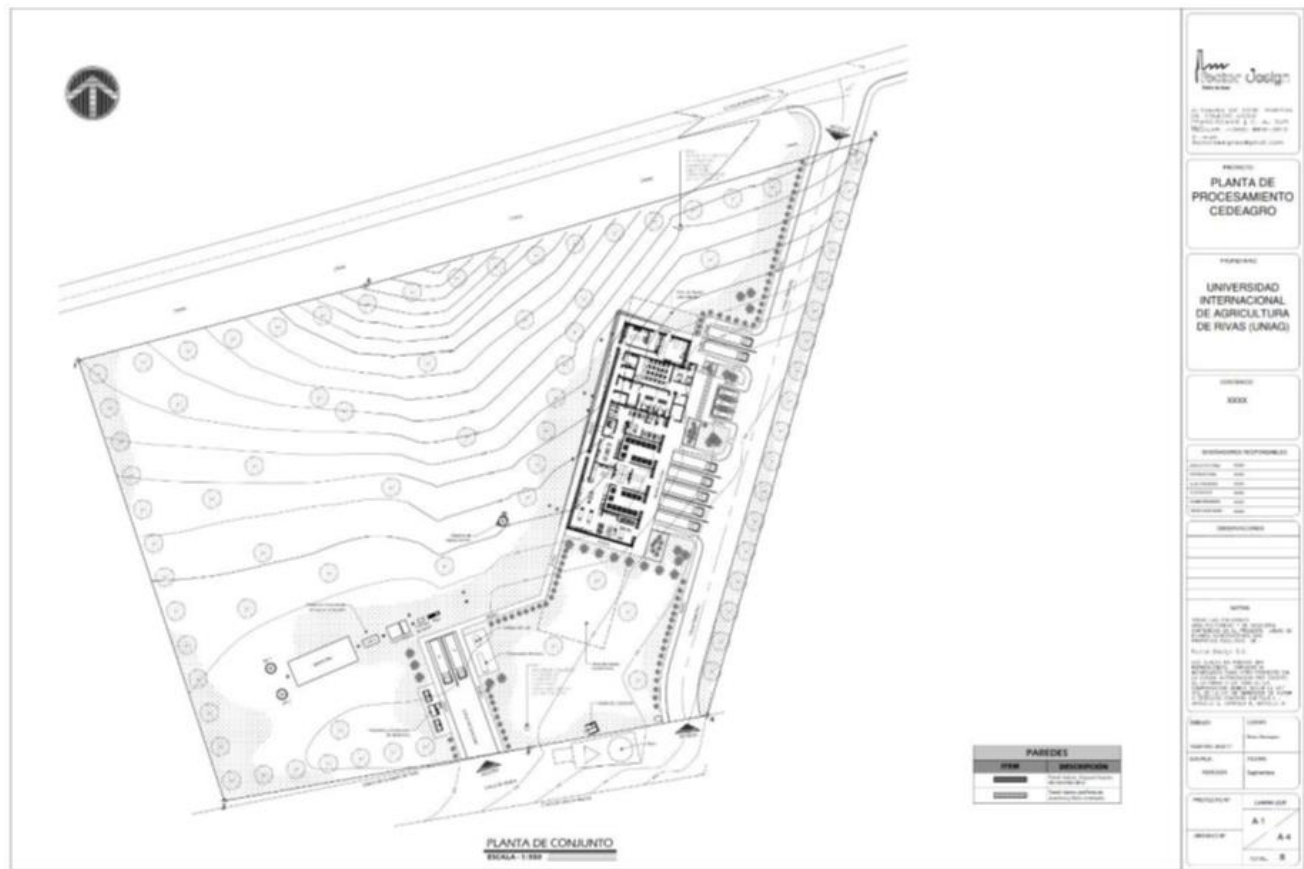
Planta Arquitectónica de Conjunto, UNIAV-CEDEAGRO.
